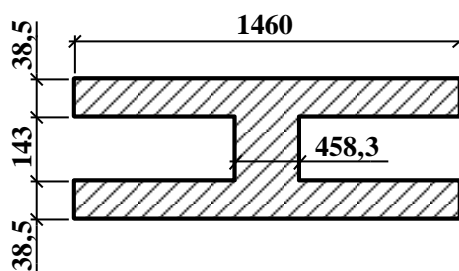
Поперечное сечение многопустотной плиты.
